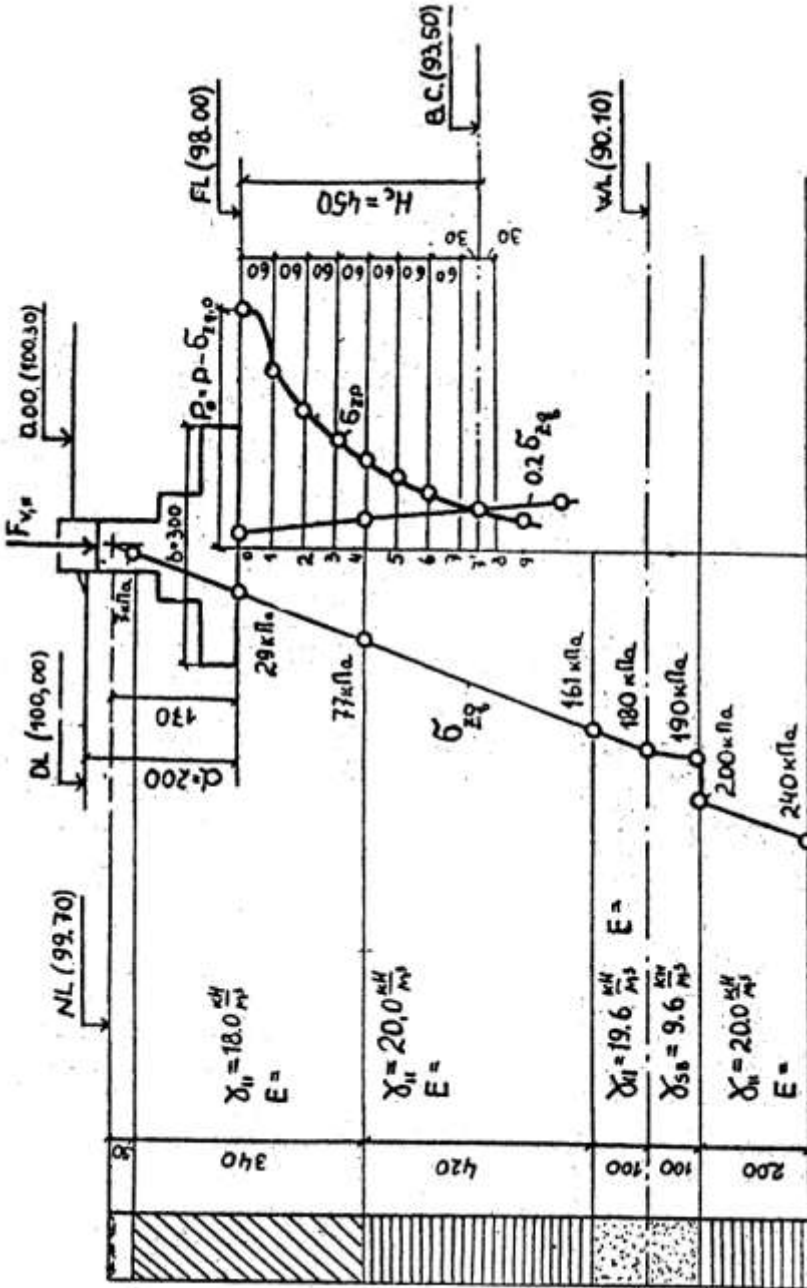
Схема для расчета осадки фундамента мелкого заложения методом послойного суммирования (линейные размеры приведены в см).
